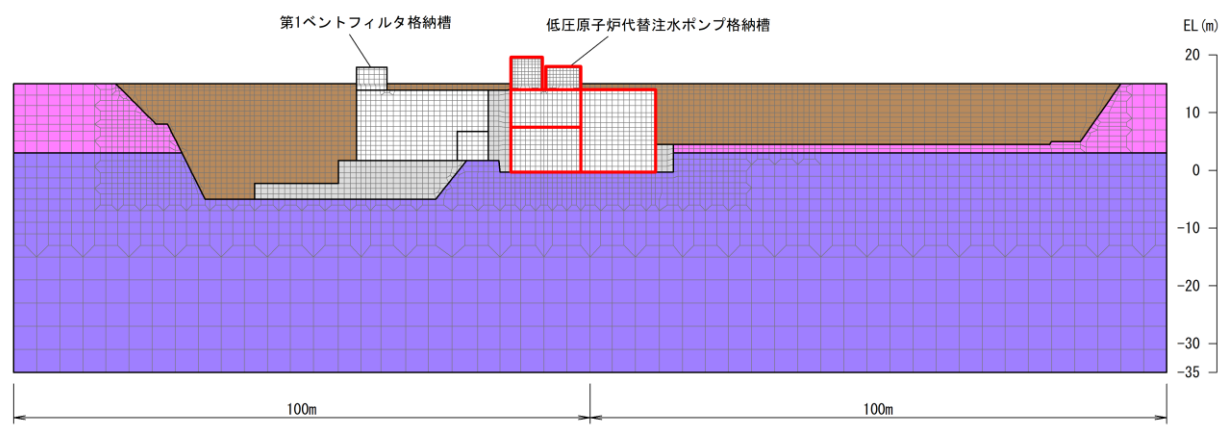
低圧原子炉代替注水ポンプ格納槽 地震応答解析モデル図 (C-C断面)
